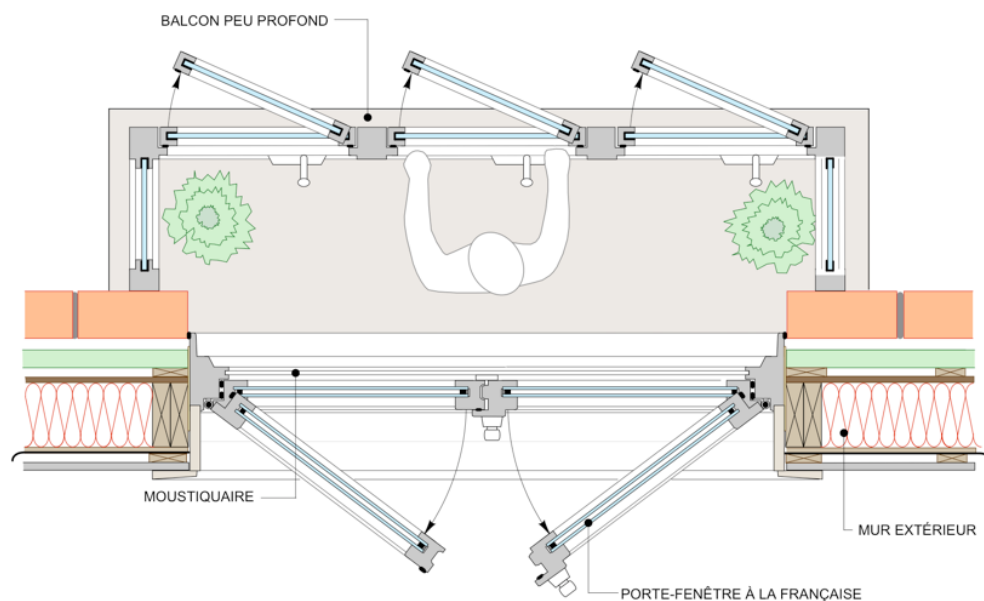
b : Ajout d'un oriel sur un balcon étroit avec porte-fenêtre ouvrant à la française
